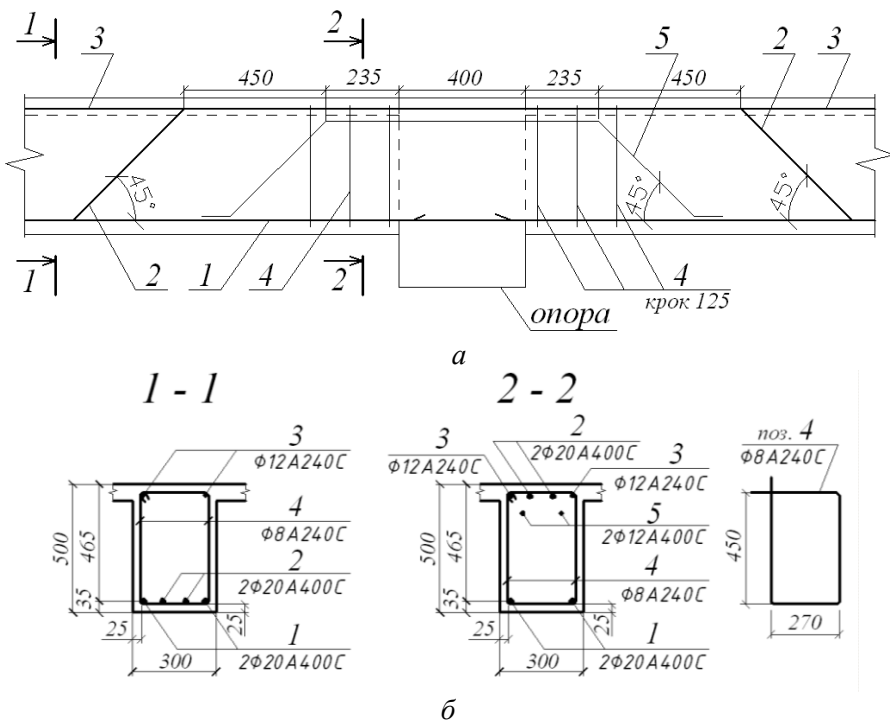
Армування балки поперечною вертикальною арматурою та відігнутими стержнями: а – вид збоку; б – перерізи 1 – 1; 2 – 2
